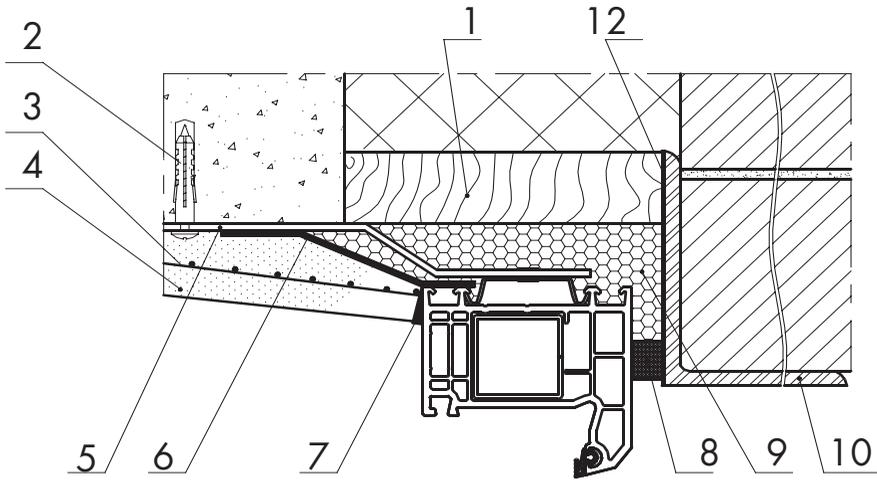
Узел верхнего примыкания оконного блока к перемычке из стального уголка в проеме многослойной стены с облицовкой кирпичом
